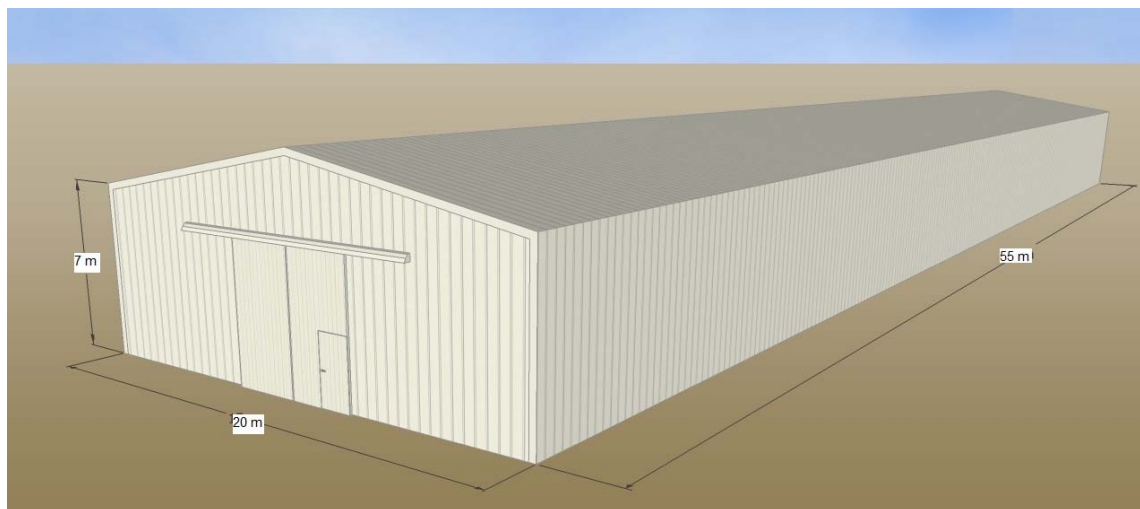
Armazém tipo a instalar (adaptado de Frisomat.pt)
